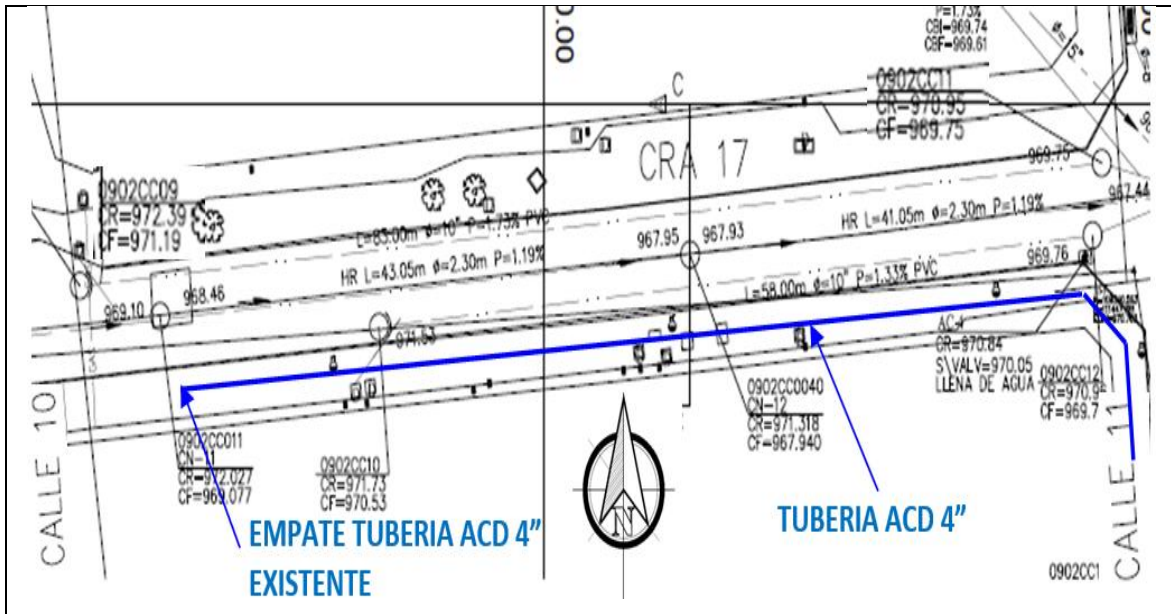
Instalación de accesorios de tubería de 4” en la calle 11 entre carrera 18 y 17.
